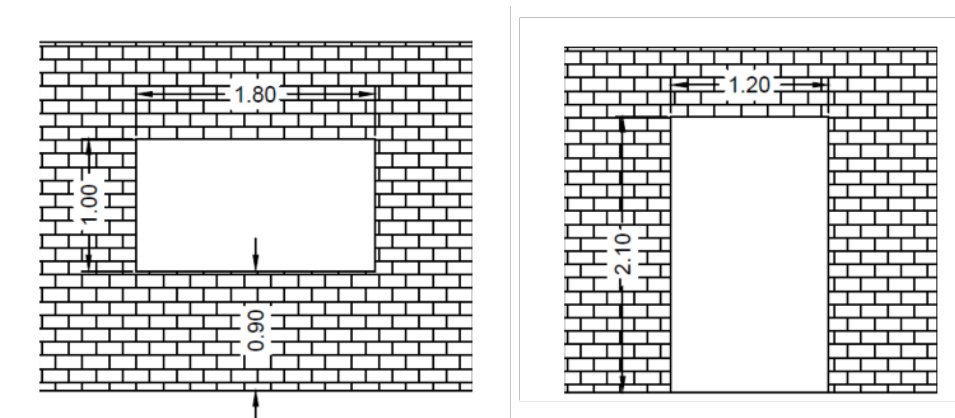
Aberturas en los muros de mampostería. Fuente: Tomado de Bravo y Flores (2015)
